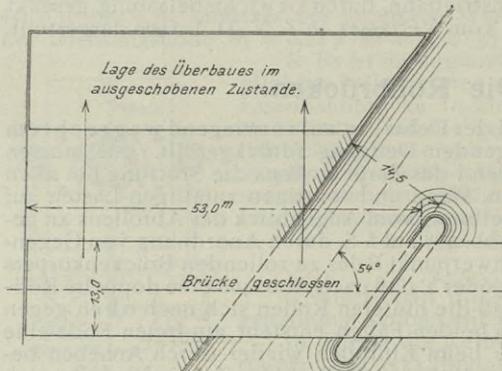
Verschiebung rechtwinklig zur Brückenachse.
